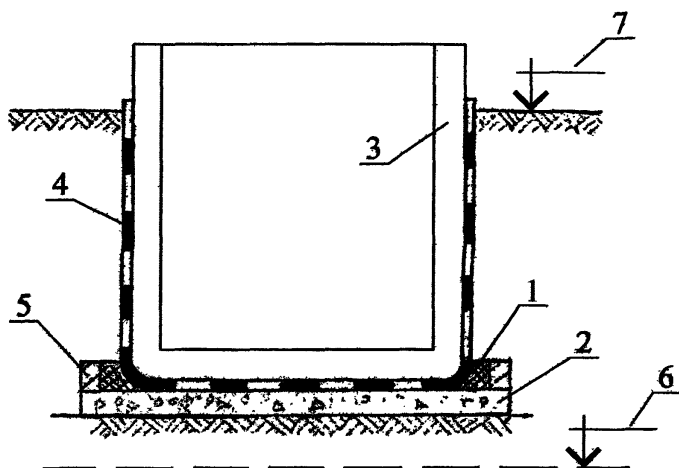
Гидроизоляция заглубленных сооружений от грунтовой капиллярной влаги
